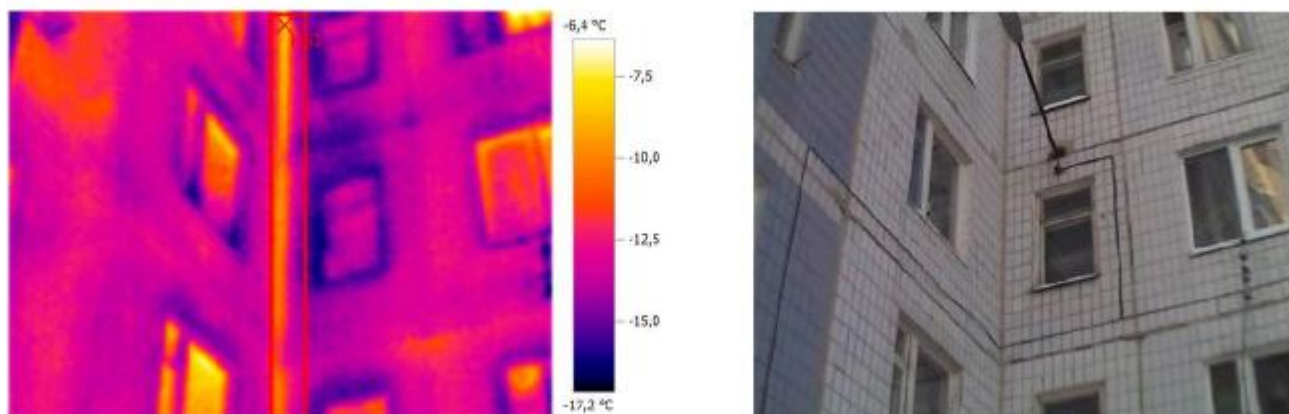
Тепловизионное и реальное изображение углового фасада здания.
